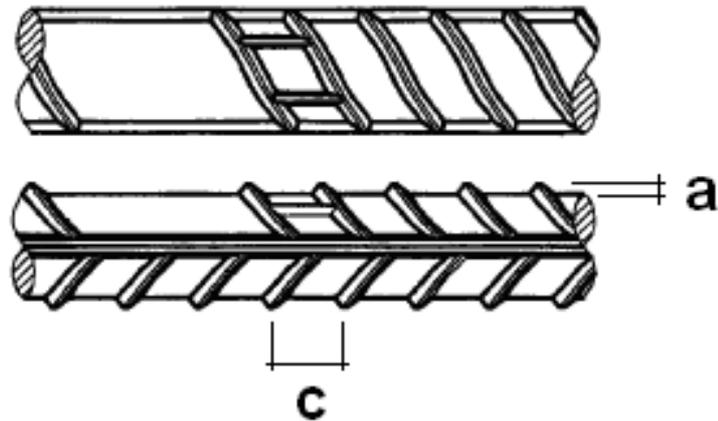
Geometría de las corrugaciones de las barras.
